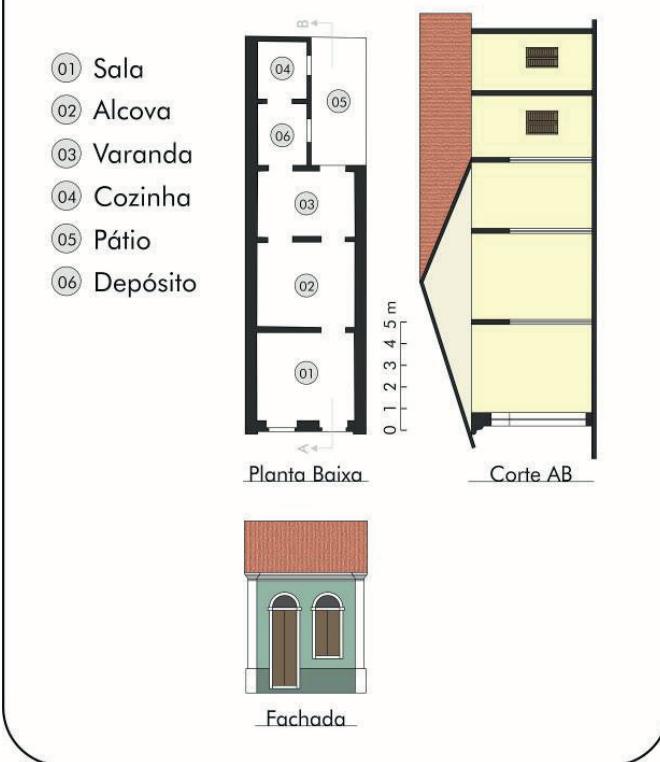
Desenho esquemático de fachada, corte e planta baixa de uma porta-e-janela. Fonte: Adaptado de Silva Filho, (1998).
